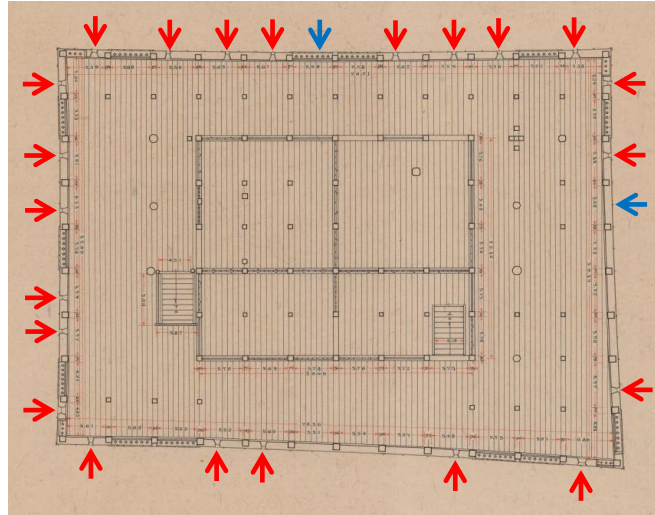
2階平面図 (部分) 姫路市立城郭研究所蔵
